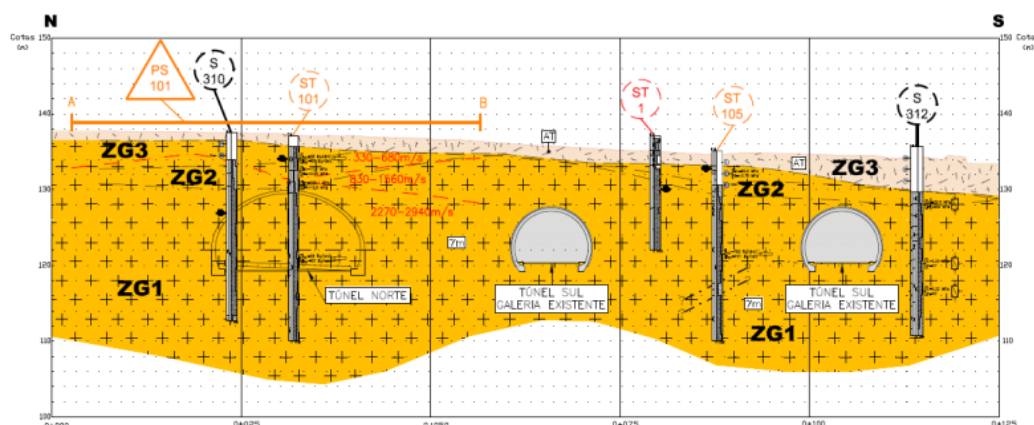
Perfil geológico transversal – Emboquilhamento Poente
